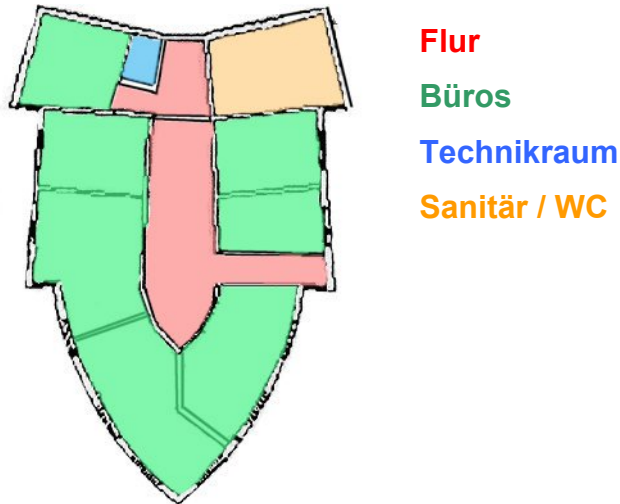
Schematischer Grundriss: Erdgeschoss Büroflügel Süd
